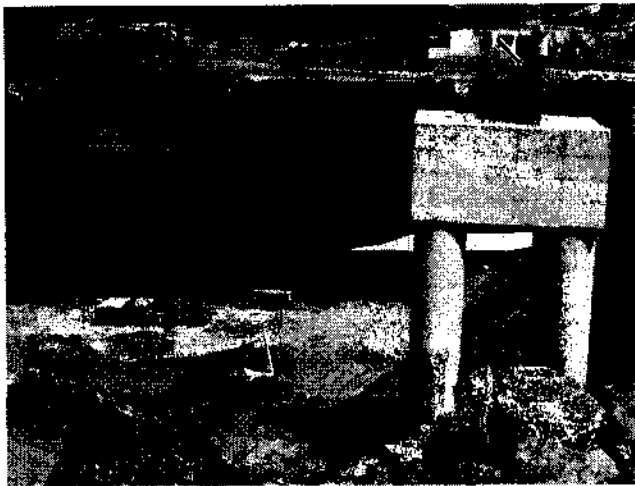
Pilares para construção de viaduto - relocação via férrea EFRS MG/RJ / área próxima à UHE Anta.
